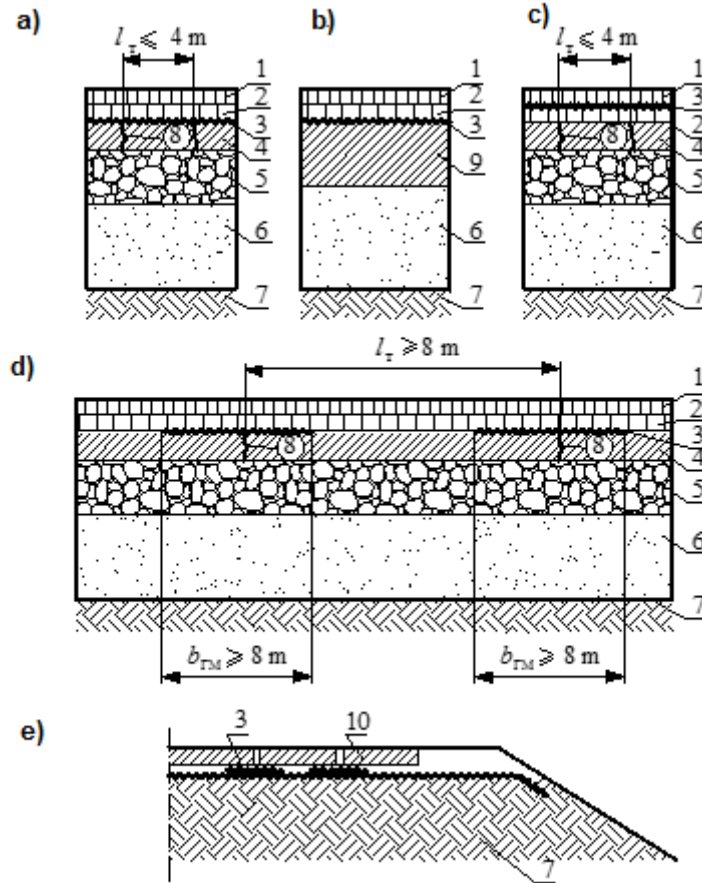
Основные конструктивные решения по устройству защитно-армирующих прослоек из ГМ в слоях асфальтобетонного (а-д) и под сборным железобетонным покрытием (е)
